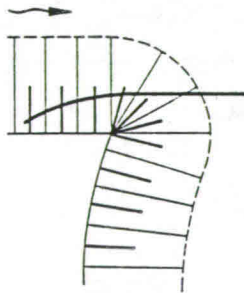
Bovenstroomse begrenzing van de scheepvaartopening
